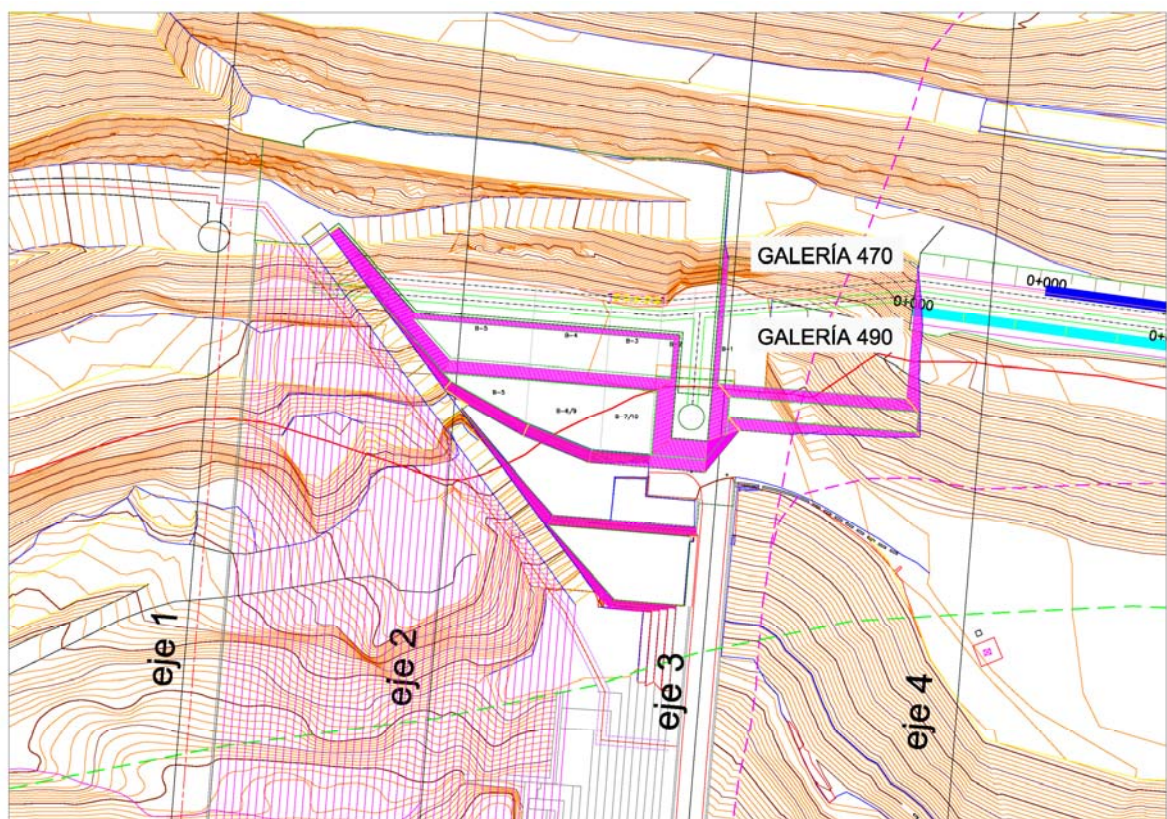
Planta topográfica del alcance de los muros jardinera en ejecución situados entre las dos presas y sobre el bloque 0 de la presa actual. El eje 1 corresponde al eje de la futura presa y el eje 3 al eje de la presa actual. Puede verse como los muros jardinera tapizan la ladera sobre el plinto de la nueva presa.
